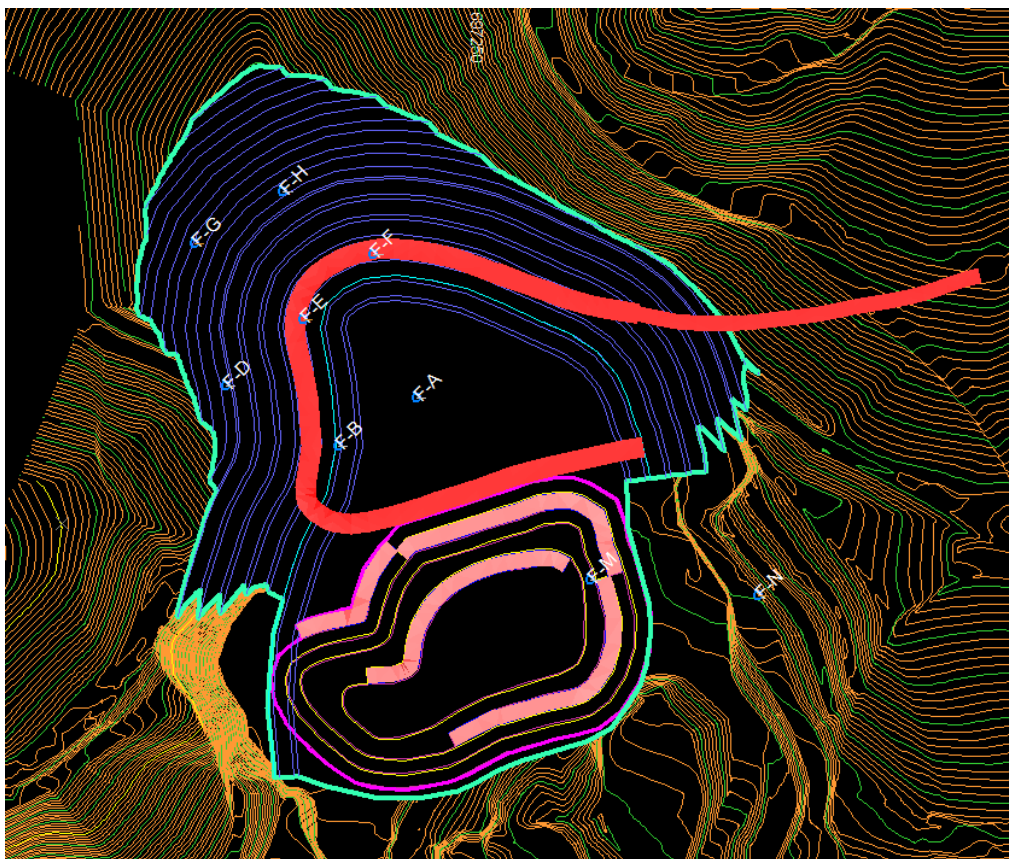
Vista em planta do Pit Final da ampliação (em azul) e do rebaixamento da cava (em rosa) gerada pelo software de Planejamento (Datamine).
